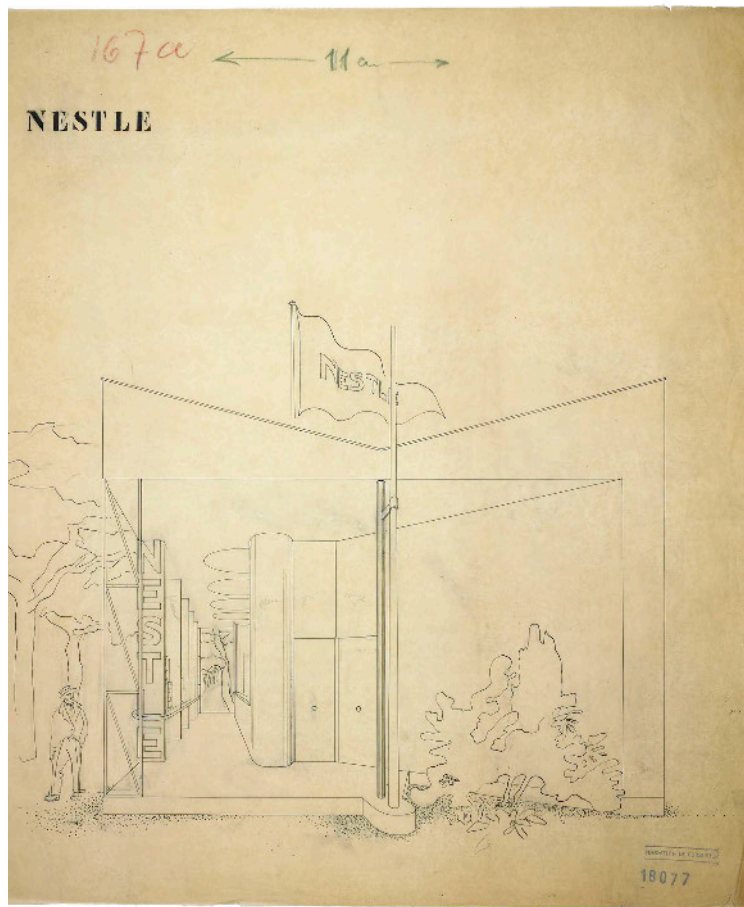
Desenho fachada lateral Pavilhão Nestlé.
